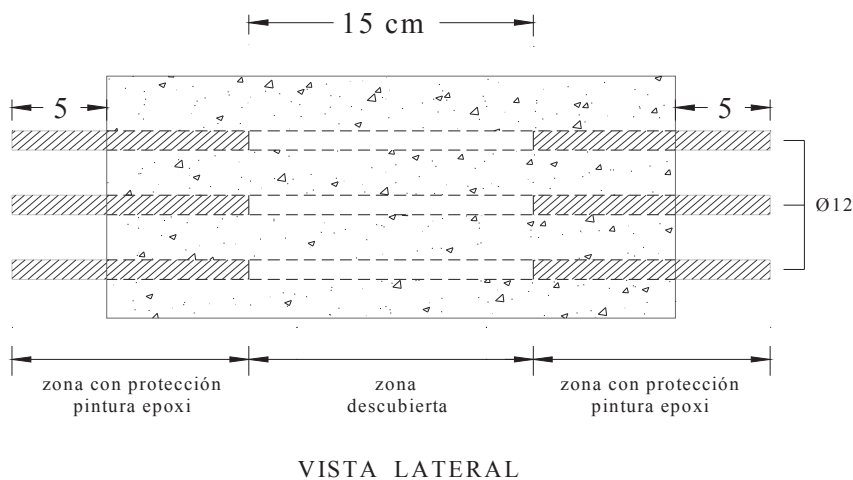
Detalle de la geometría de los ejemplares. Vista lateral
